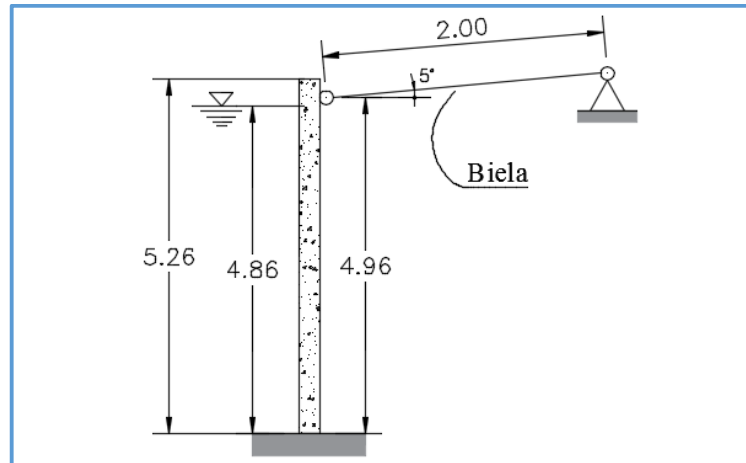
Modelo estructural del Tanque Imhoff – Tubería PVC-U
